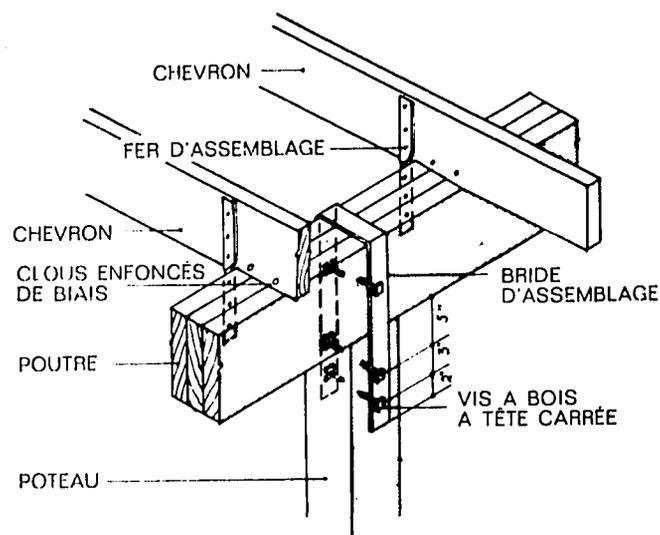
Bride d'assemblage de 57,15 mm × 4,75 mm utilisée pour rattacher la poutre au poteau.
